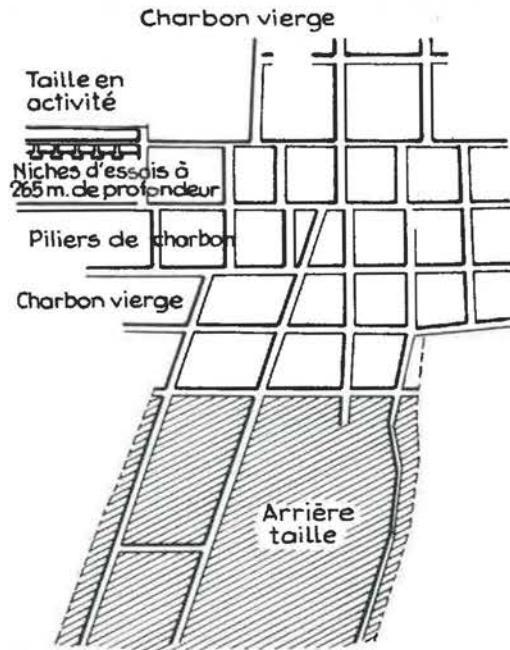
Plan donnant la situation des essais effectués dans la couche Brockwell.
